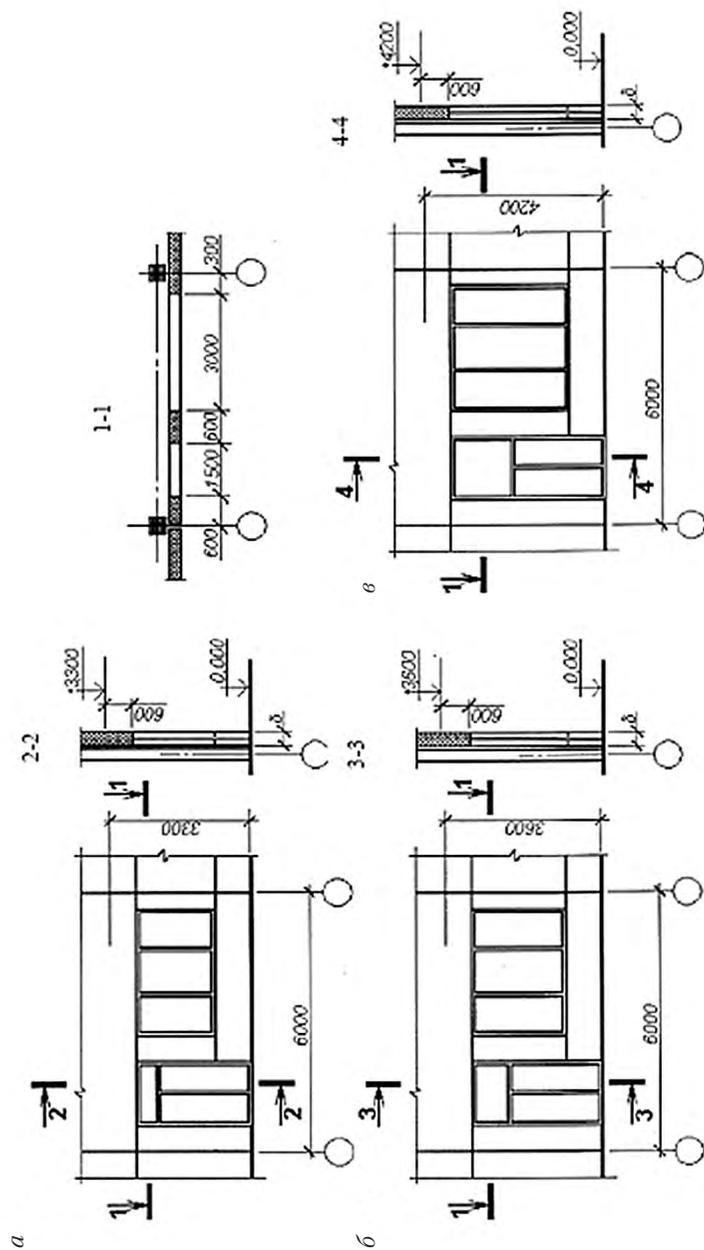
Схемы разрезки и компоновки панелей наружных стен у входов в здание:
